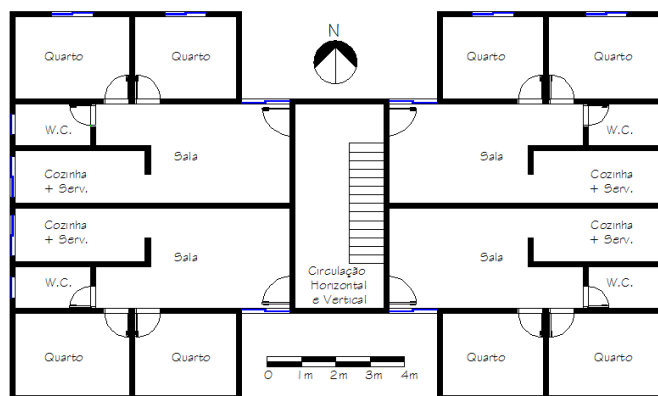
Planta Baixa do pavimento tipo do estudo de caso 1.
